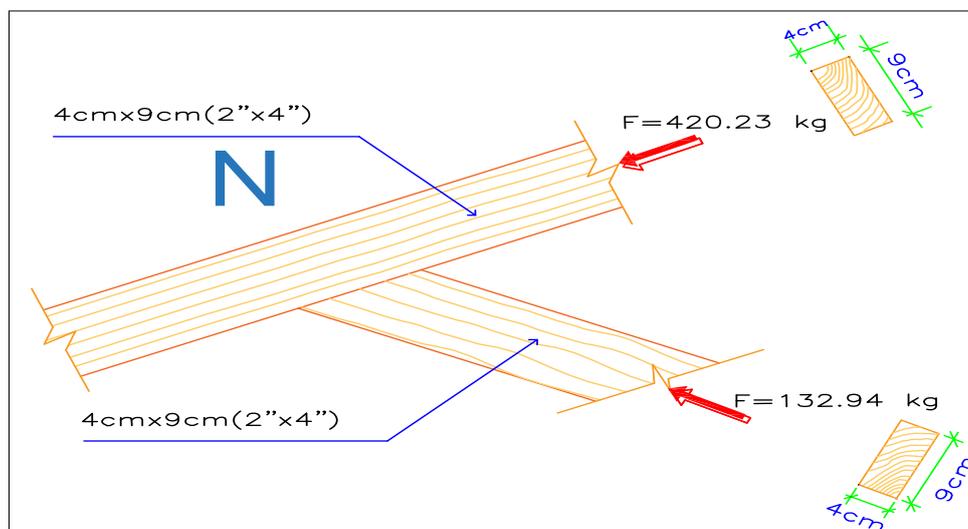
Nudo "N" de la armadura tipo montante maestro
